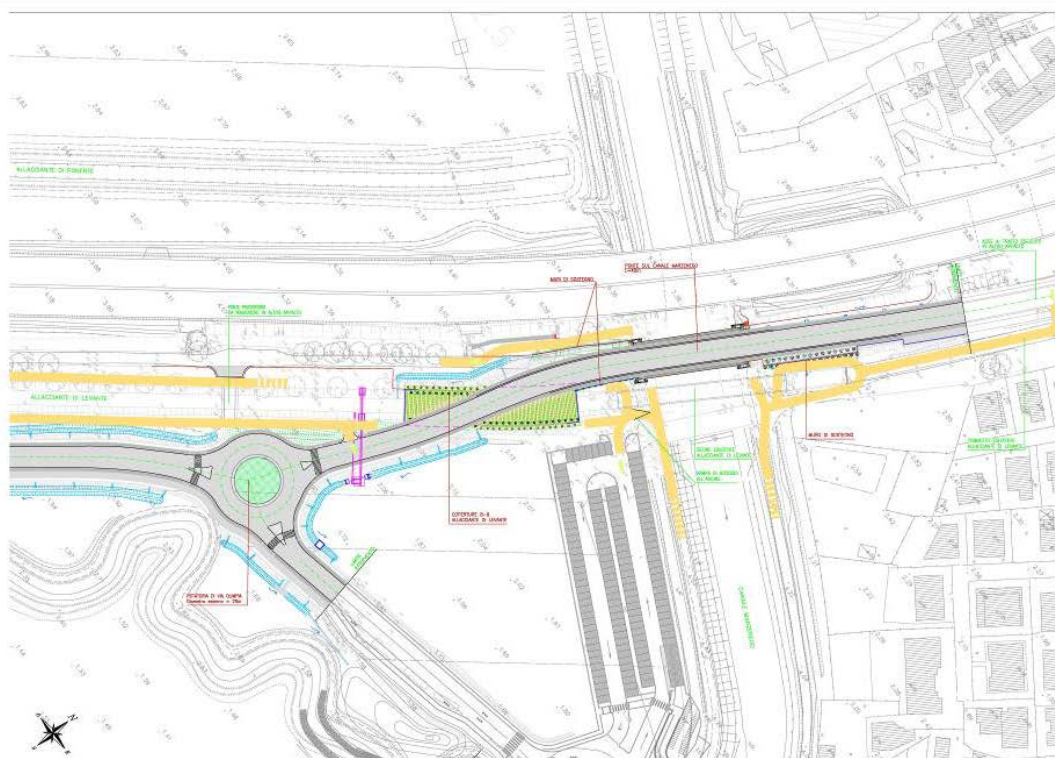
Percorsi argini consortili – Stralcio planimetrico zona nord
